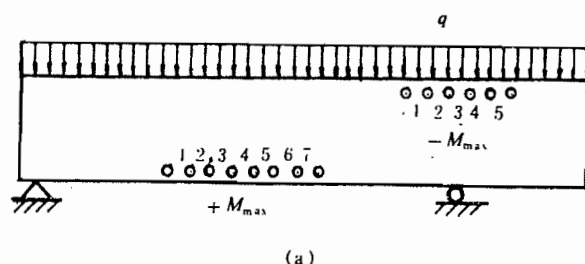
钢筋混凝土受拉区抗裂测点布置
